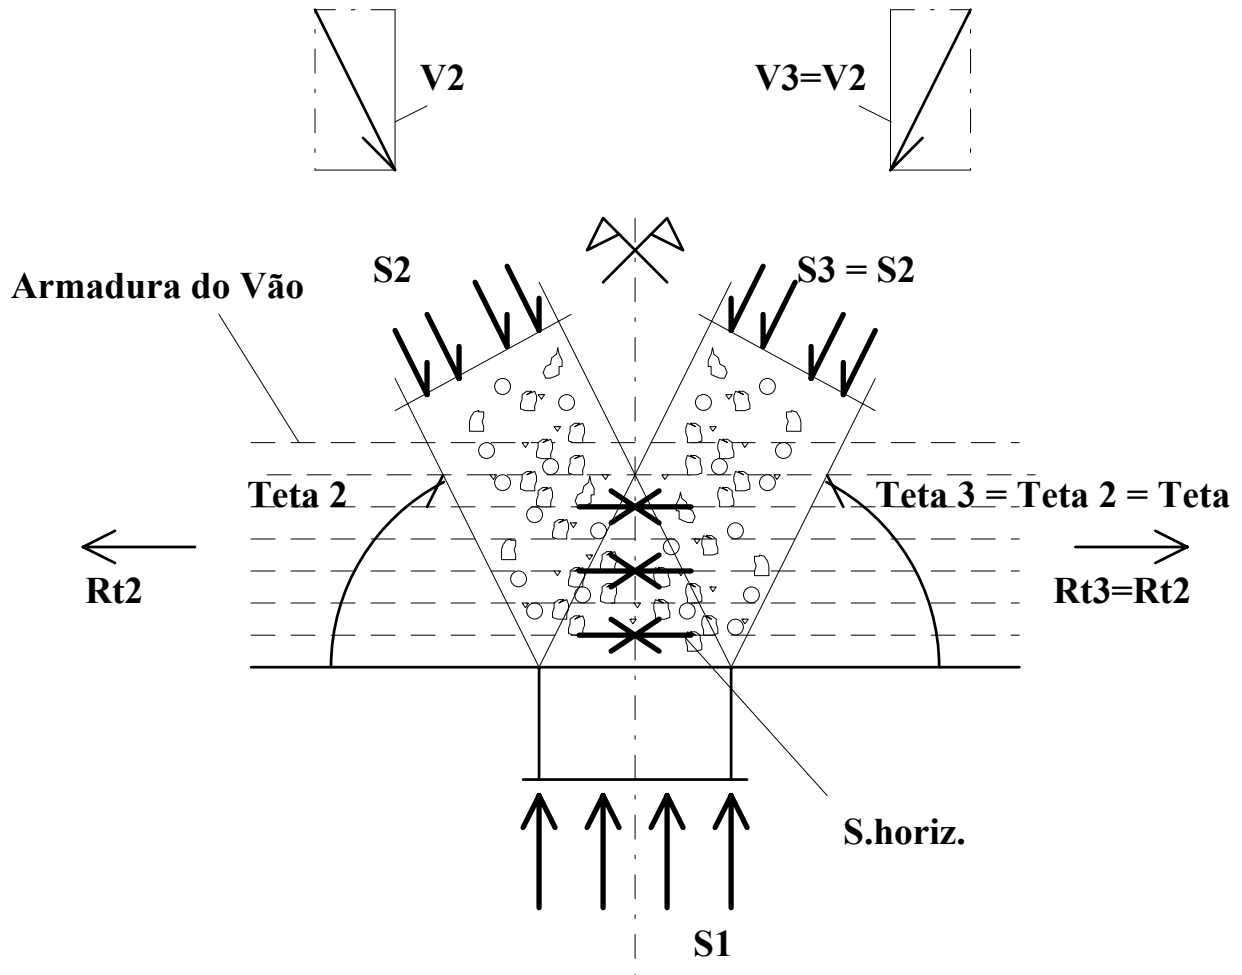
Apoio central de Viga Parede apoiada em um pilar.
